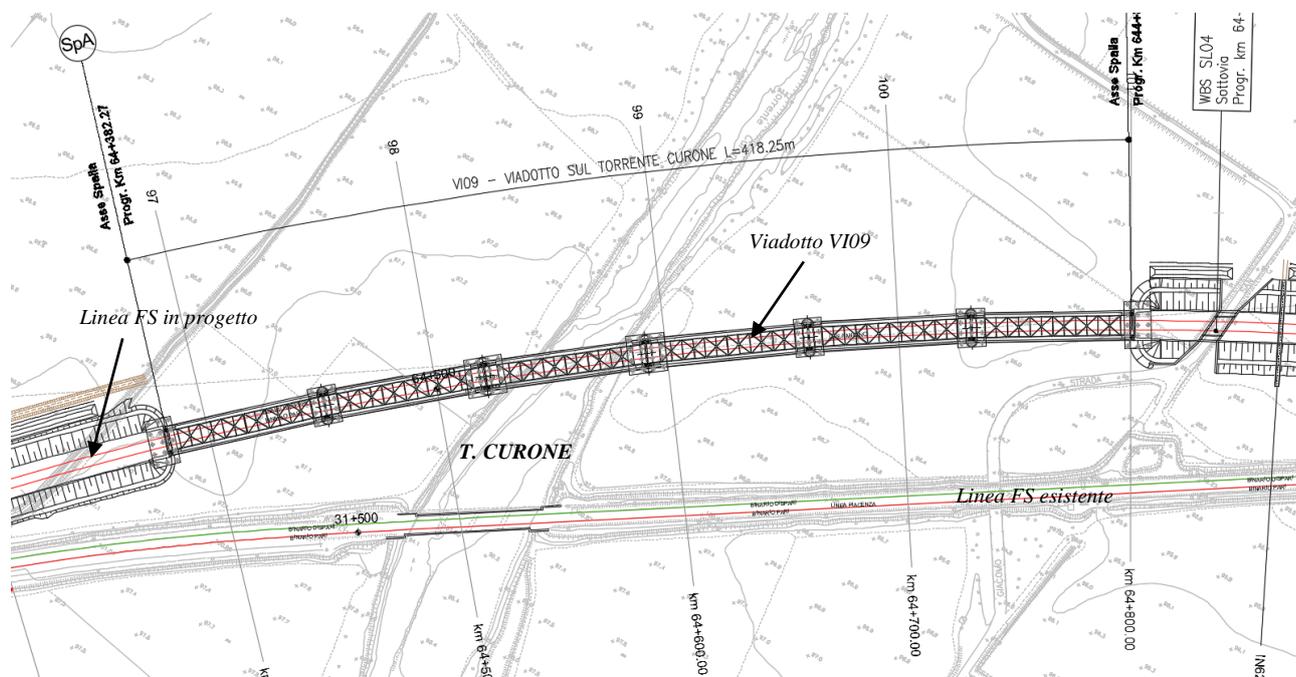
Torrente Curone: pianta dell'opera di attraversamento in progetto
